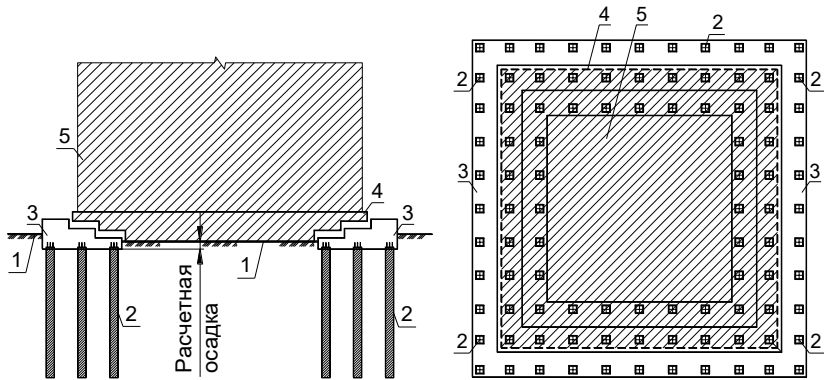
Схема возведения свайно-плитного фундамента:
